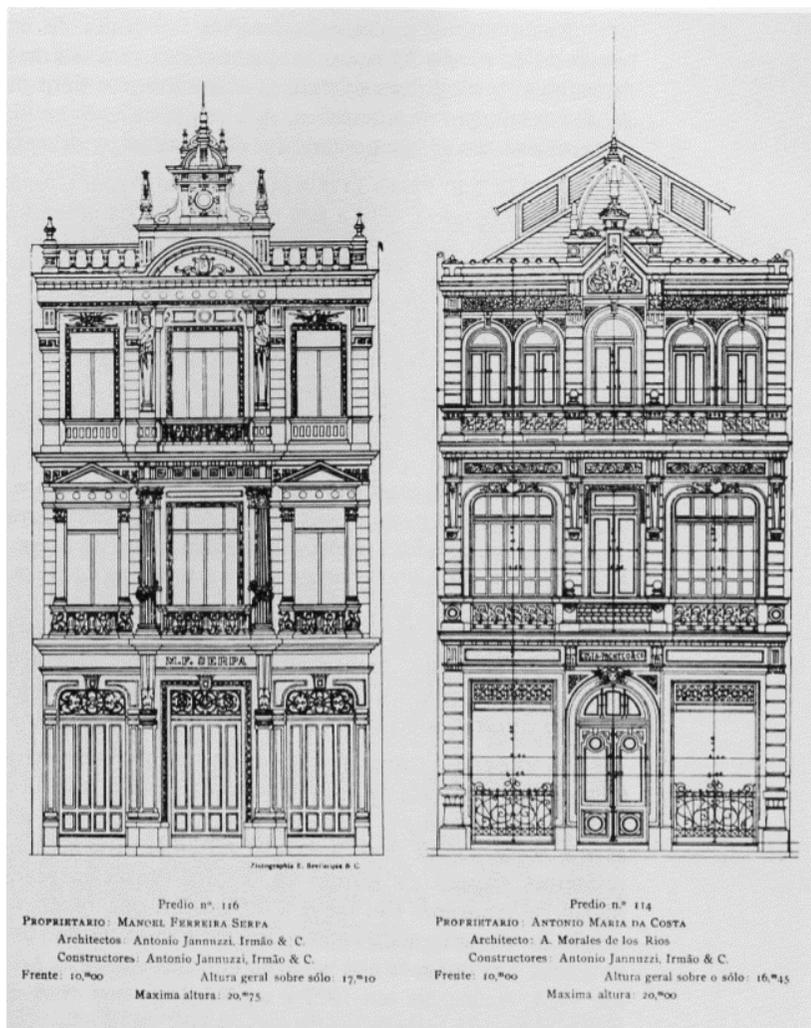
Fotografia de projeto arquitetônico de prédio na Avenida Central do Rio de Janeiro (Marc Ferrez, 1903).
